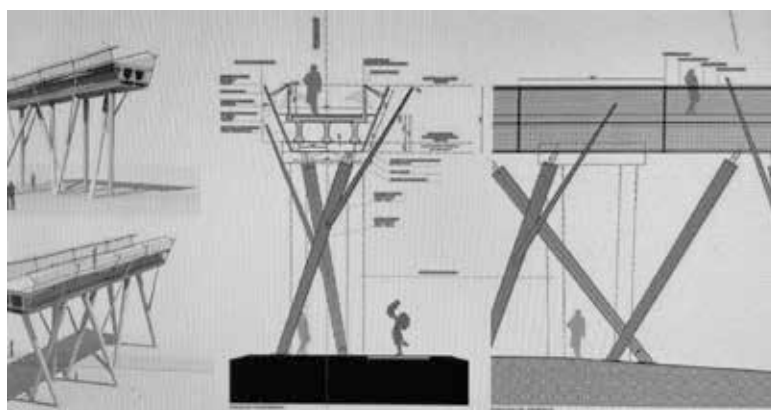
Progetto di consolidamento e di ambientazione dell'Ing. Enzo Siviero
